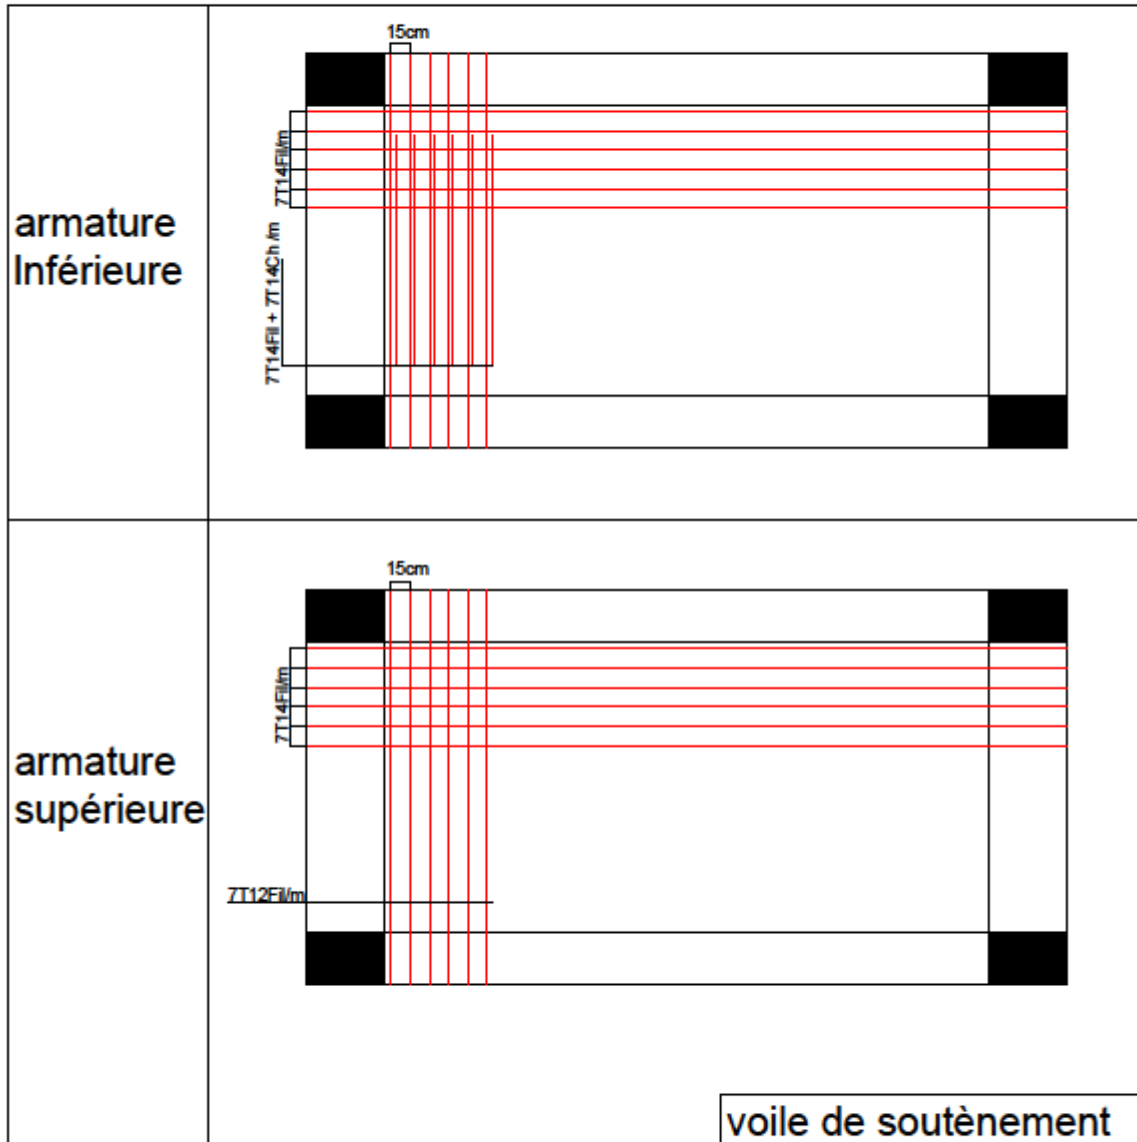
Schéma de ferrailage du voile de soutènement
